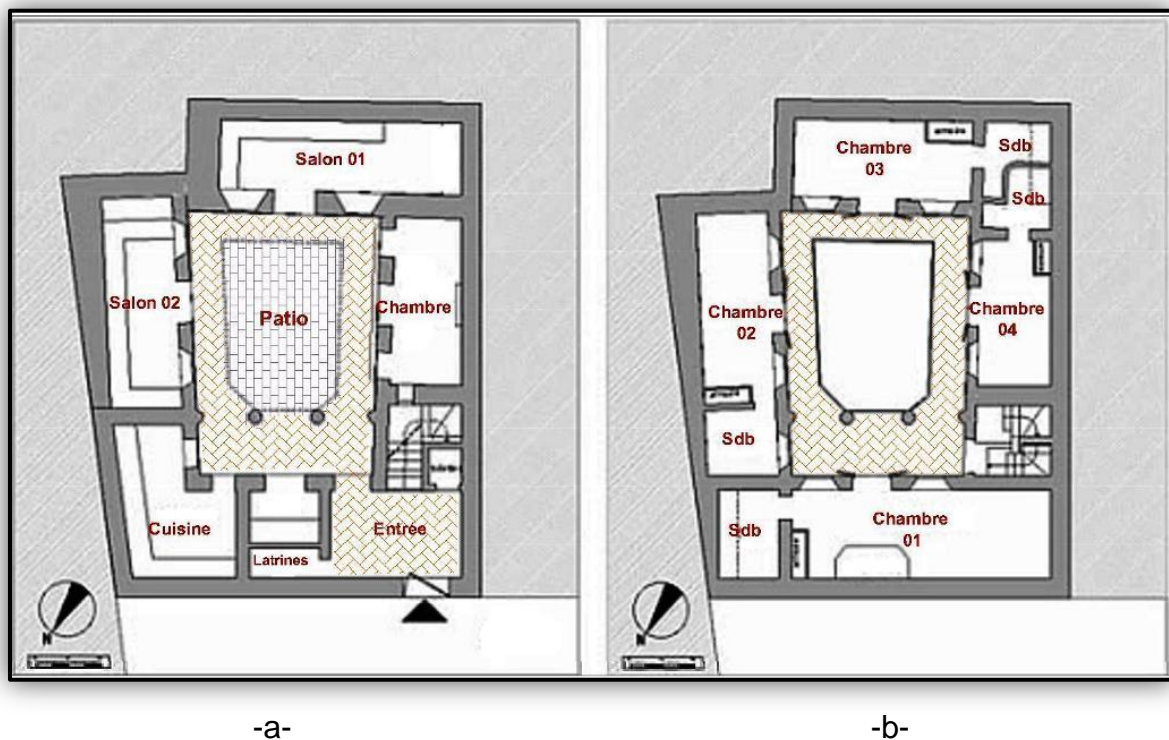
Plan d'une maison traditionnelle à Marrakech, -a- Plan rez de chaussé, -b- Plan étage.
